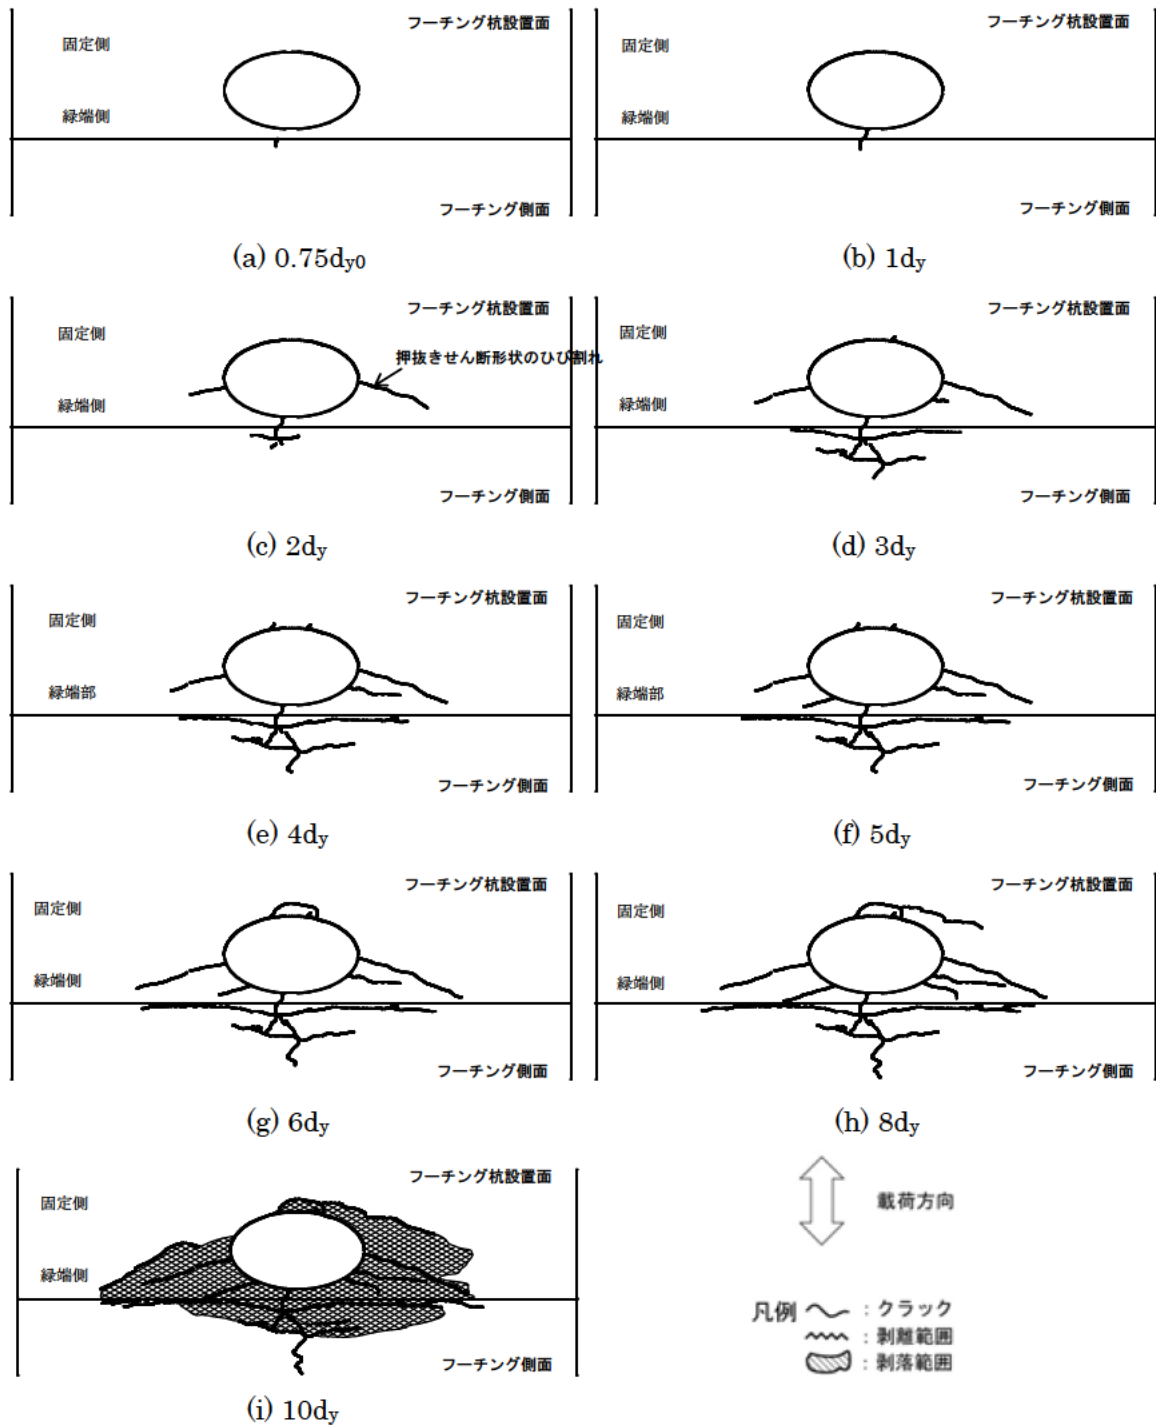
杭設置面フーチングのひび割れ進行状況図 (Case CPP-S-3)
